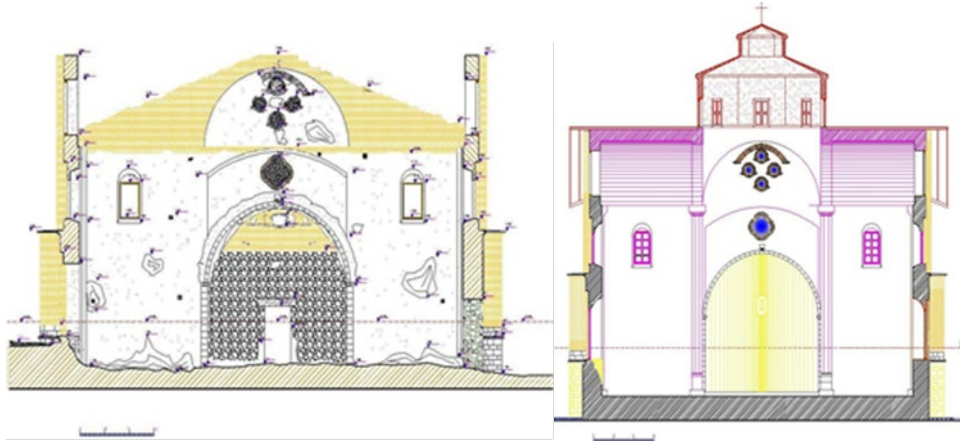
Elazığ Ermeni Protestan Kilisesi A-A Kesiti Restitüsyon (Ş. Öztürk)
